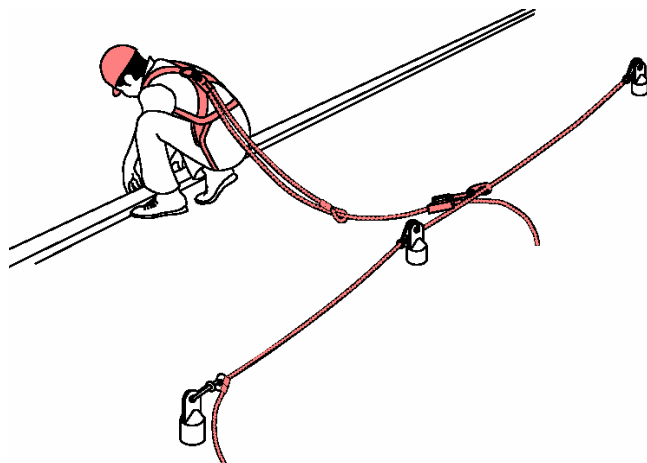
Equipamento individual de protecção num telhado plano onde não existe nenhuma barreira fixa numa distância de pelo menos 2 m do limiar do telhado
